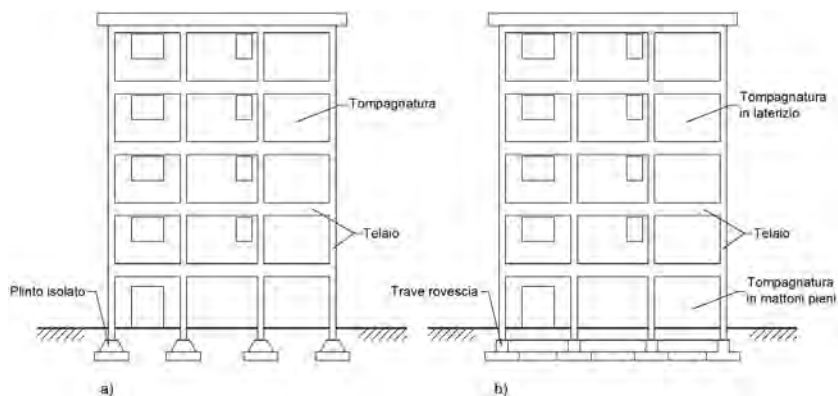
Esempio di tipica struttura a telai in c.a. tamponati con fondazioni: a) isolate e b) continue a travi rovesce
